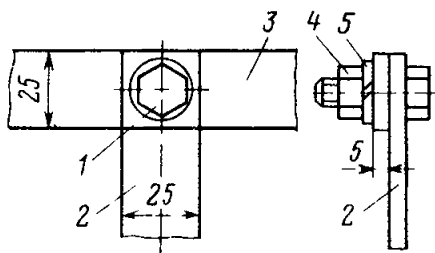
Схема присоединения заземляющего проводника из полосовой стали к заземляющему контуру или сборной заземляющей шине:
